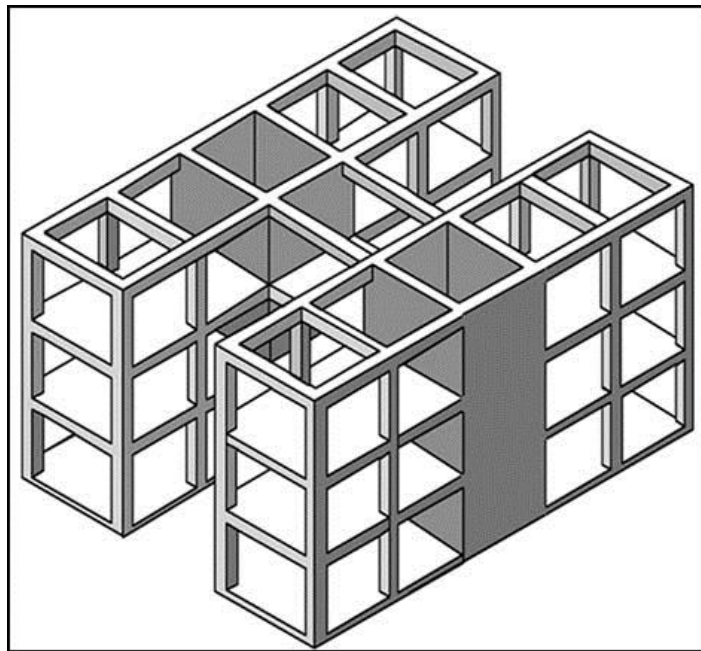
Muros ubicados en el interior de la estructura.³³
